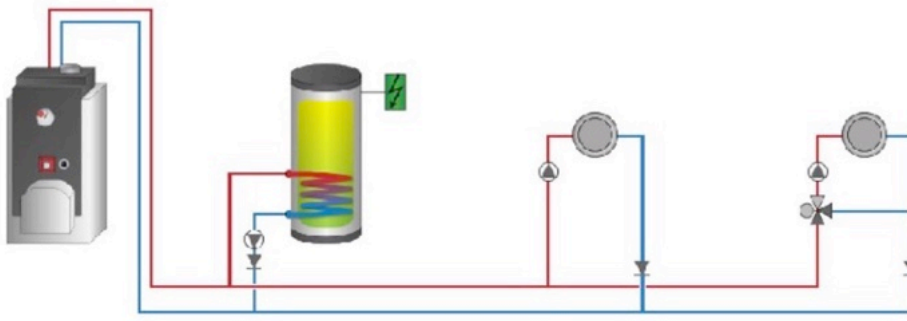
Anlagenschema zum ersten Ausbauschritt (Variante 03)
